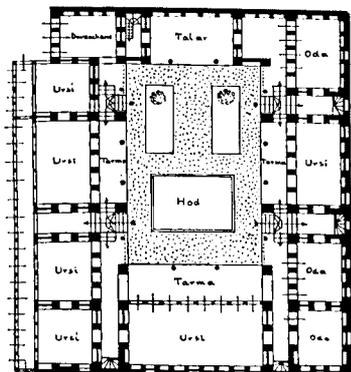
Grundriss des ersten Obergeschosses.
